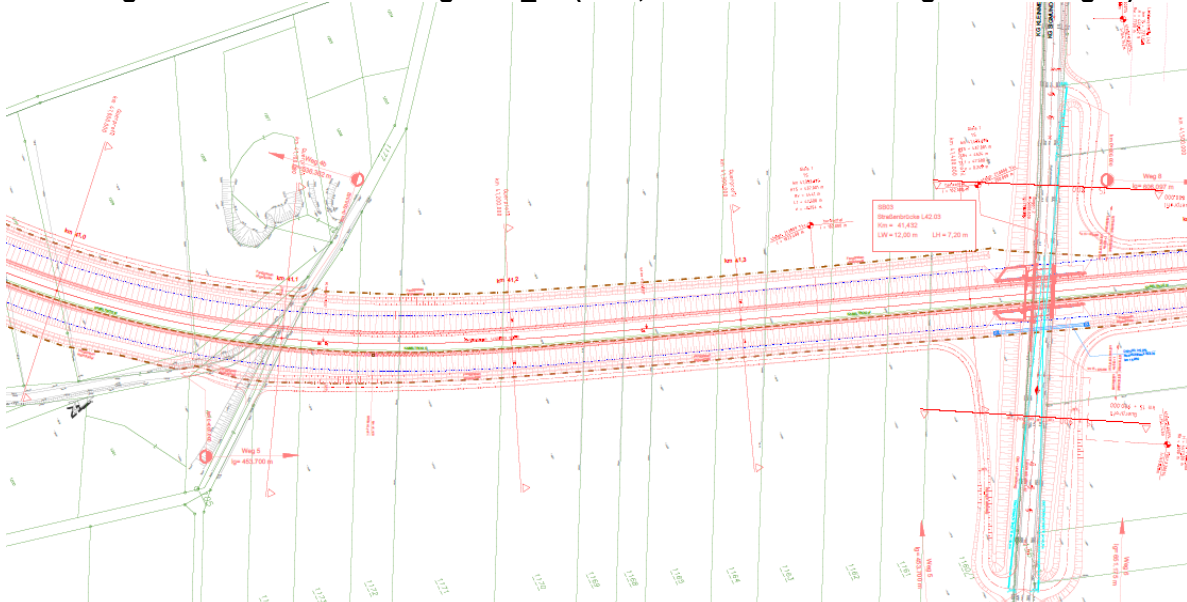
Ausschnitt aus Einlage 414_10 (Lageplan Nr. 10)
